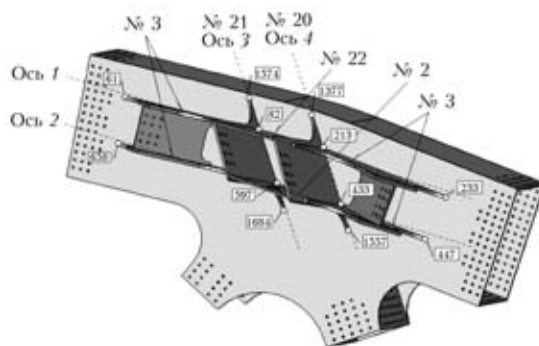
Схема сварного узла арочного пилон с указанием осей 1–4, вдоль которых необходимо оценить долговечность сварных соединений № 2, 3, 20–22 (цифры в рамке — контрольные точки, узлы)
